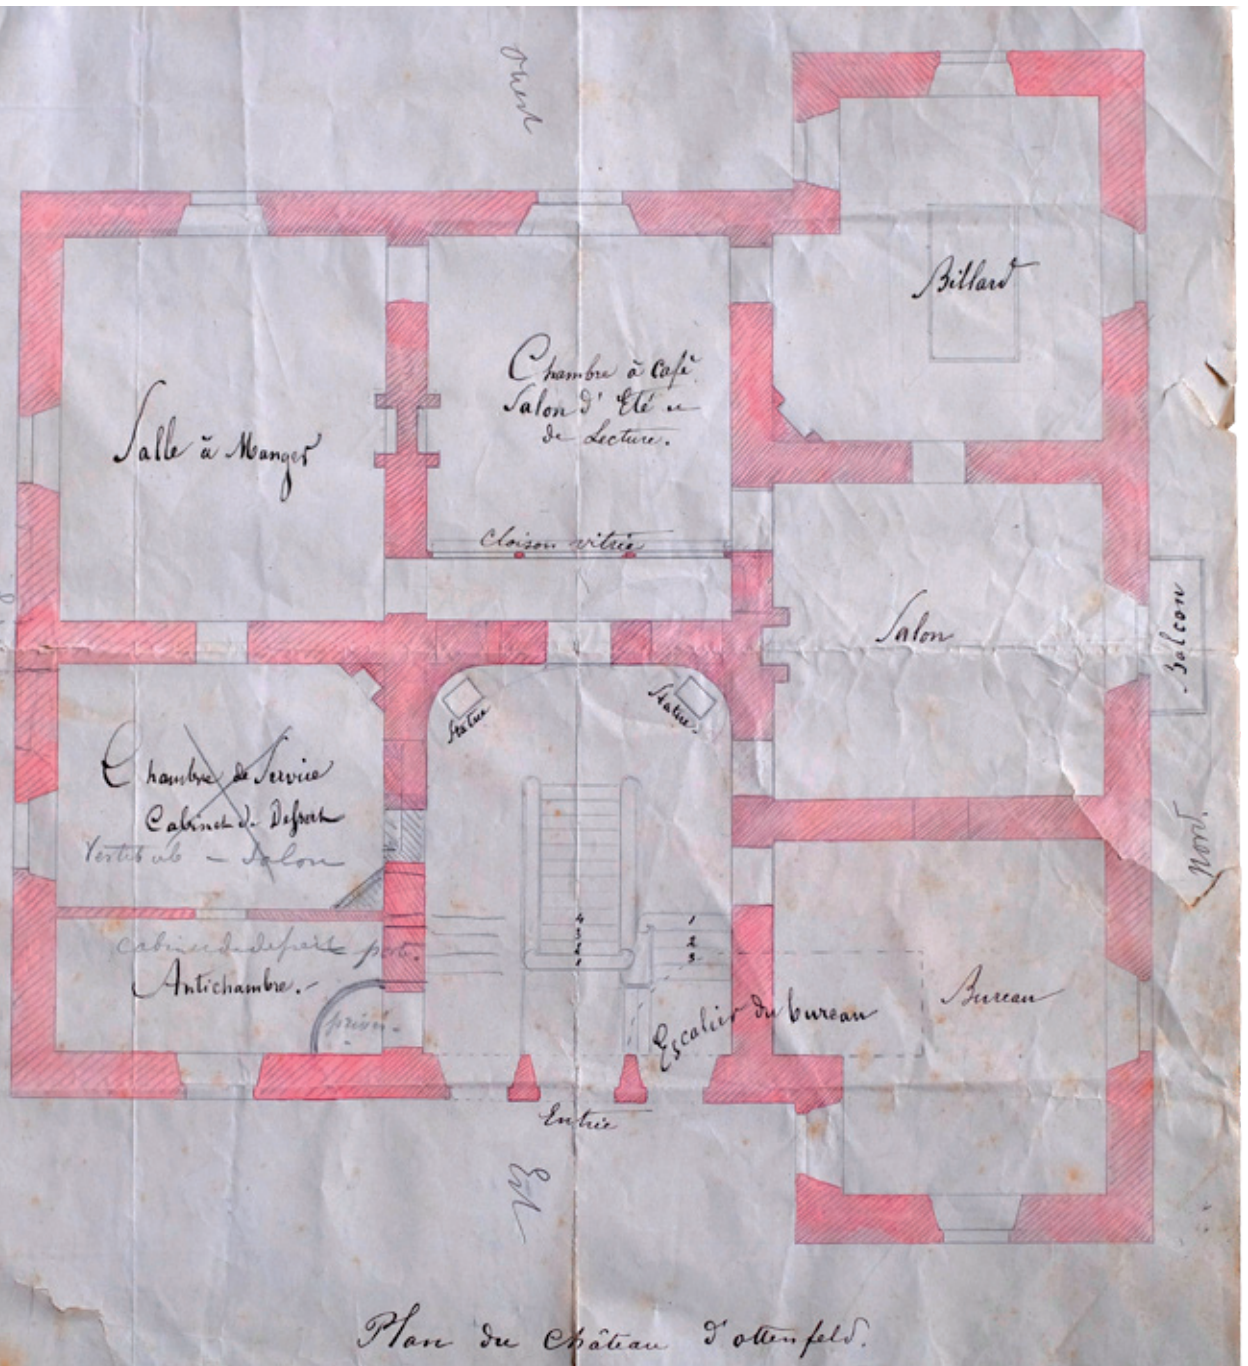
Grundriss Schloss Ottenfeld 1. Obergeschoss, Joseph von Blanckart zugeschrieben (Privatbesitz, Foto B.L. 2022).
